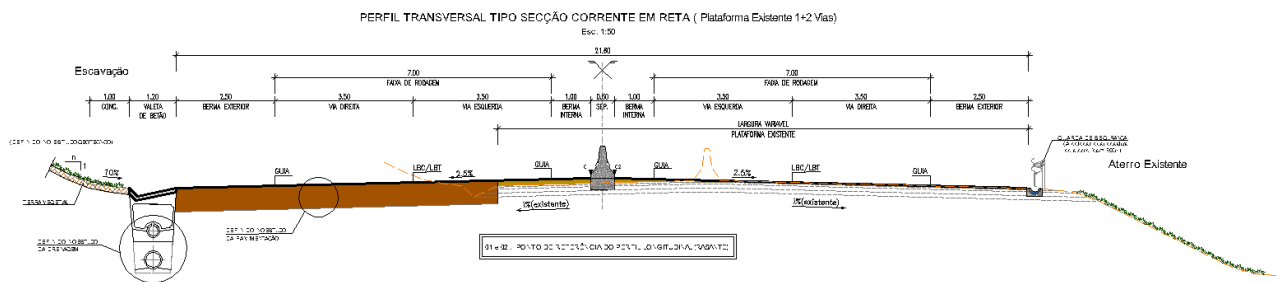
Perfil transversal tipo da seção corrente em reta, adotado para plataforma existente para via 1x2
